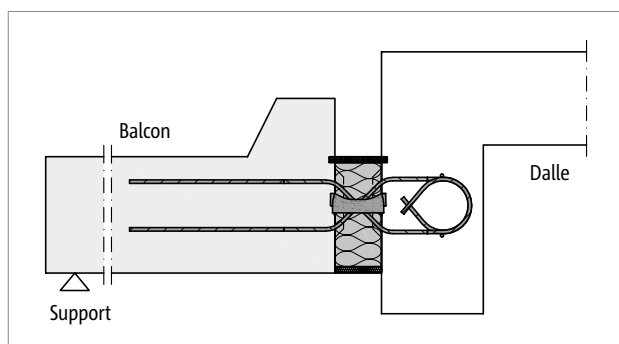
Schöck Isokorb® T Type Q-E-W-VV : Cas d'installation « dalle de balcon préfabriquée » (par exemple, type T Type Q-E-W-VV1 à VV3)
